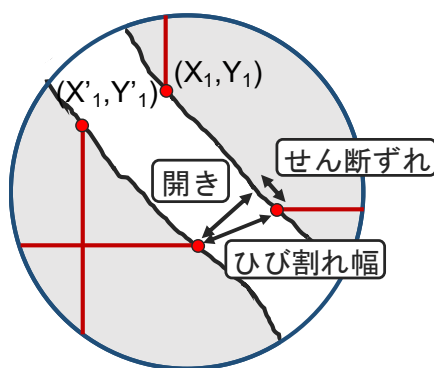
ひび割れ性状の評価方法²⁾
